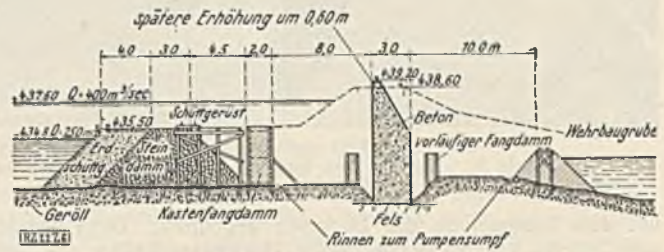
Hilfsbauten für den Bau des Betonkerns für den oberen Fangdamm im Niedrigwasserbett der Kura.
